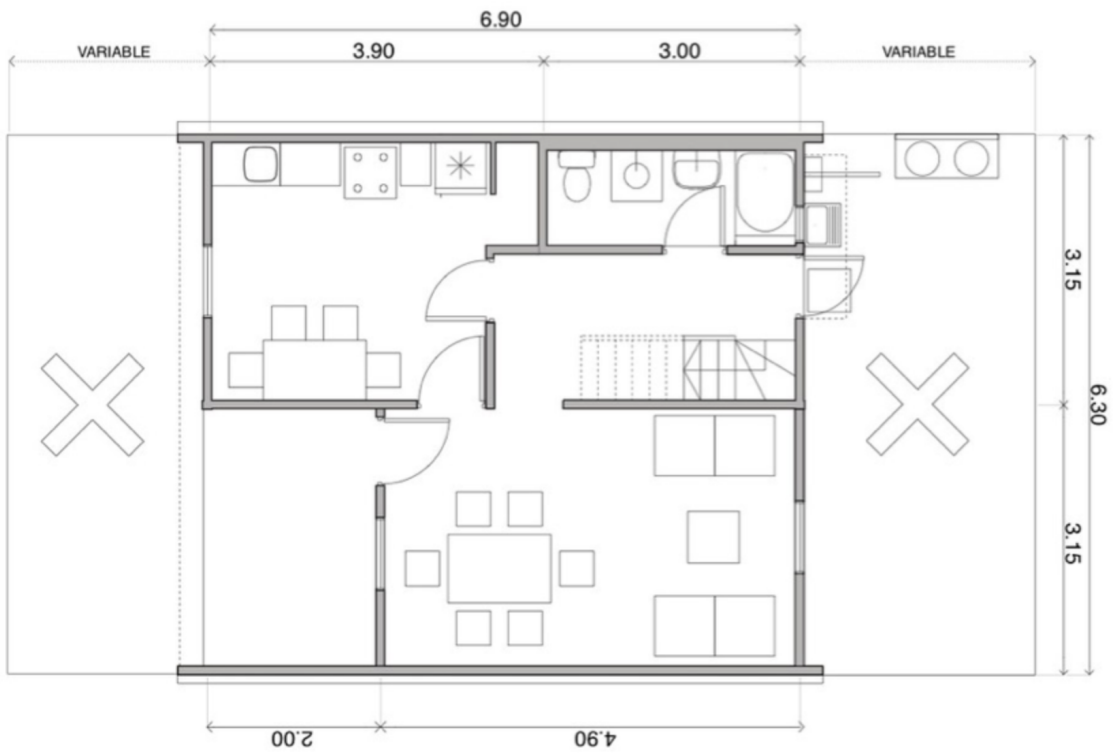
Plano del nivel 1 de la Fase 2 de la vivienda Villa Verde
